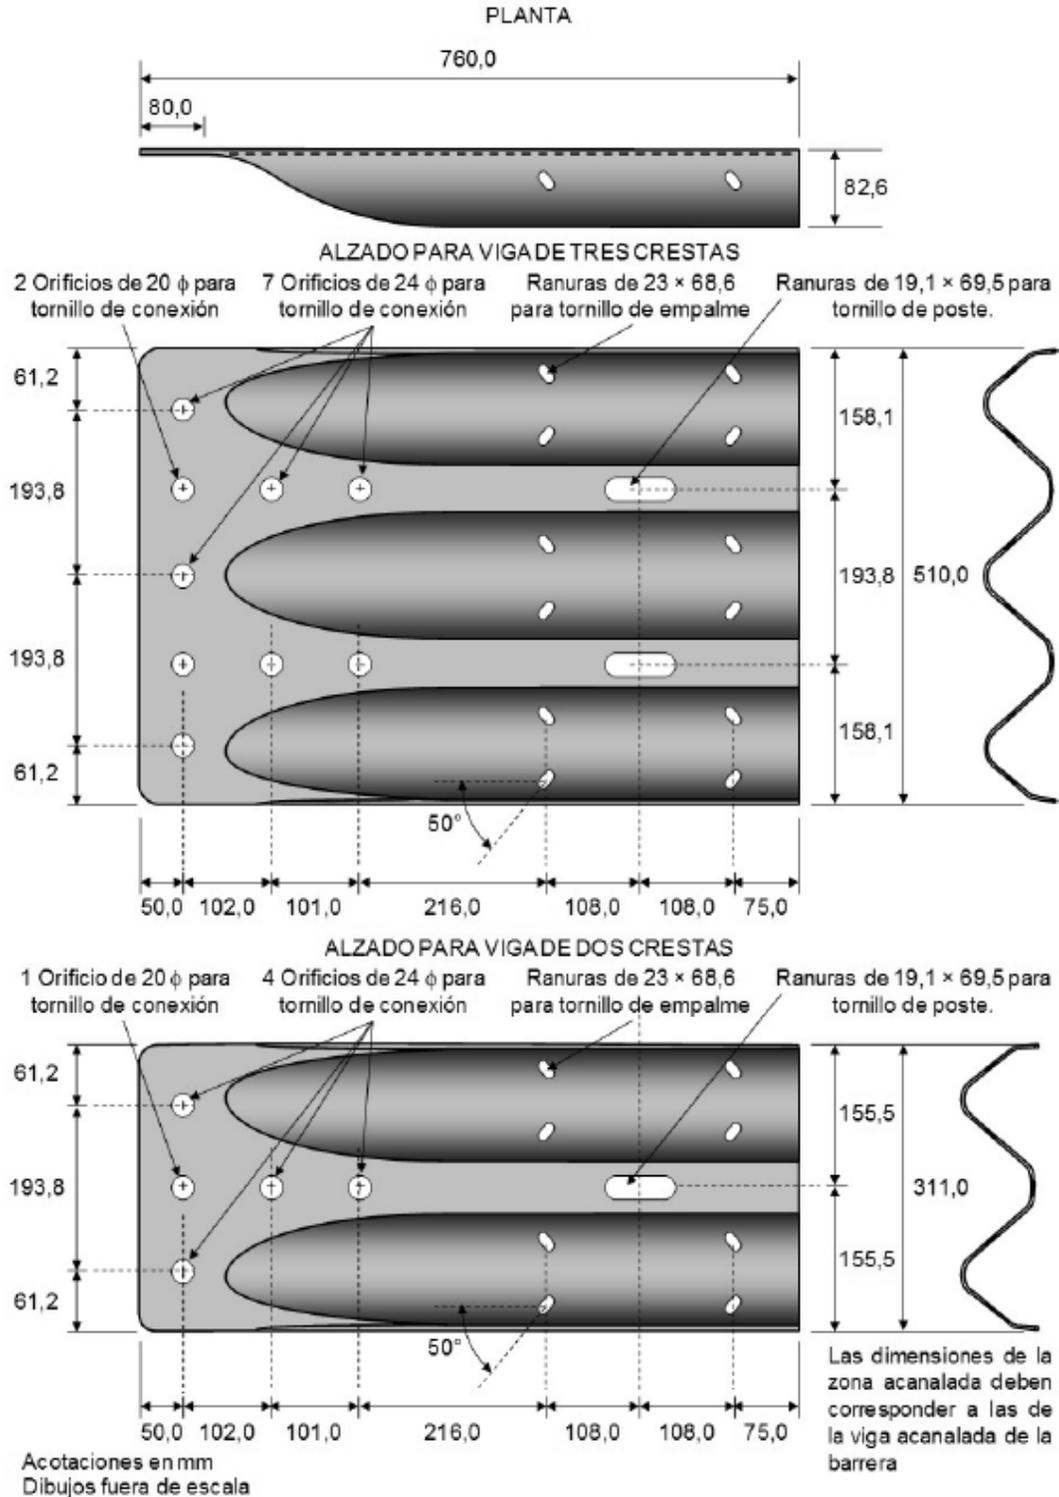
Zapatas de conexión para barreras de vigas acanaladas de acero
